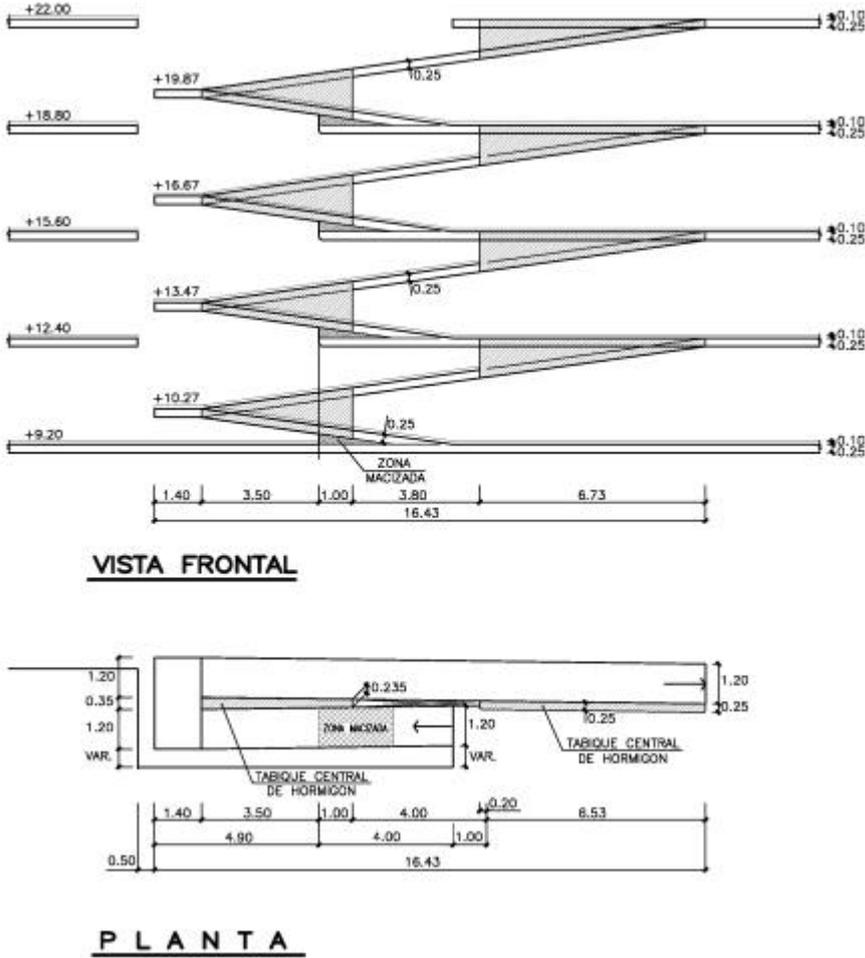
Rampas de conexión entre plantas en la Escuela de Danza
